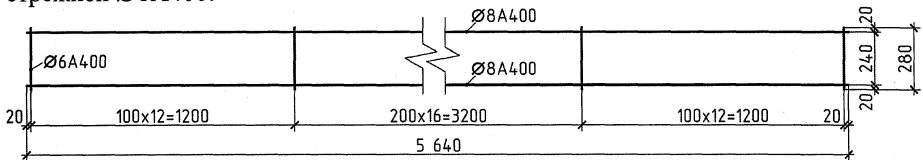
Каркас К-1 с рабочей поперечной арматурой
